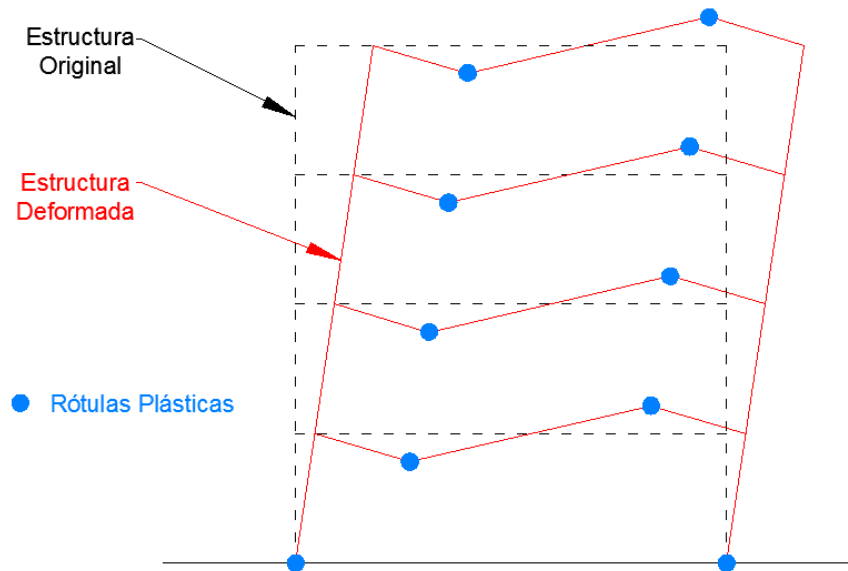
Criterio Columna Fuerte – Viga Débil.
